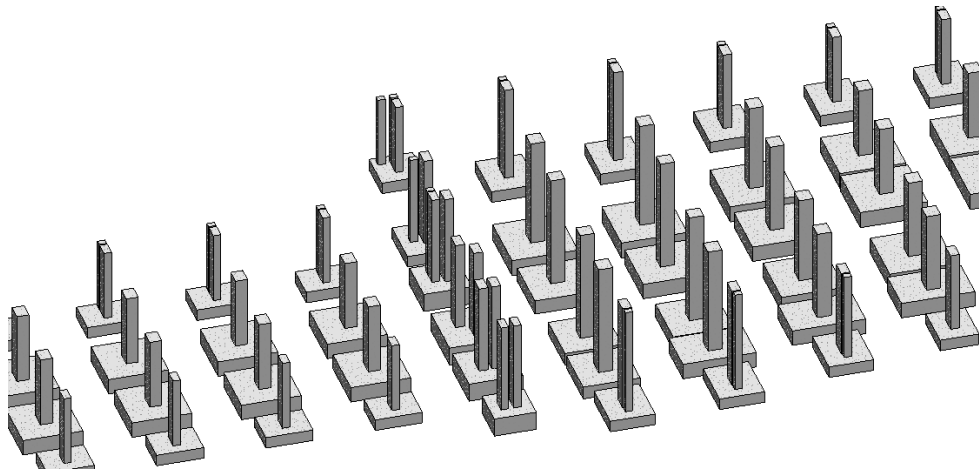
Sótano del pabellón A y B, luego de la demolición de muros y losa(HERM-Revit)
